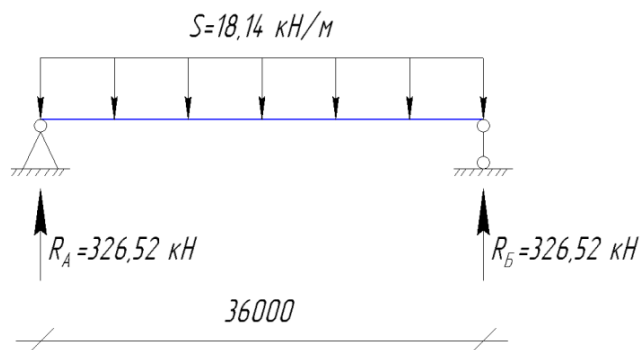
Расчетная схема ригеля для снеговой нагрузки
